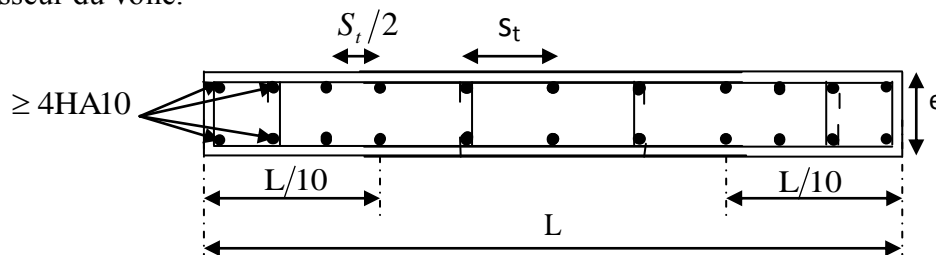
Disposition des armatures verticales dans les voiles
